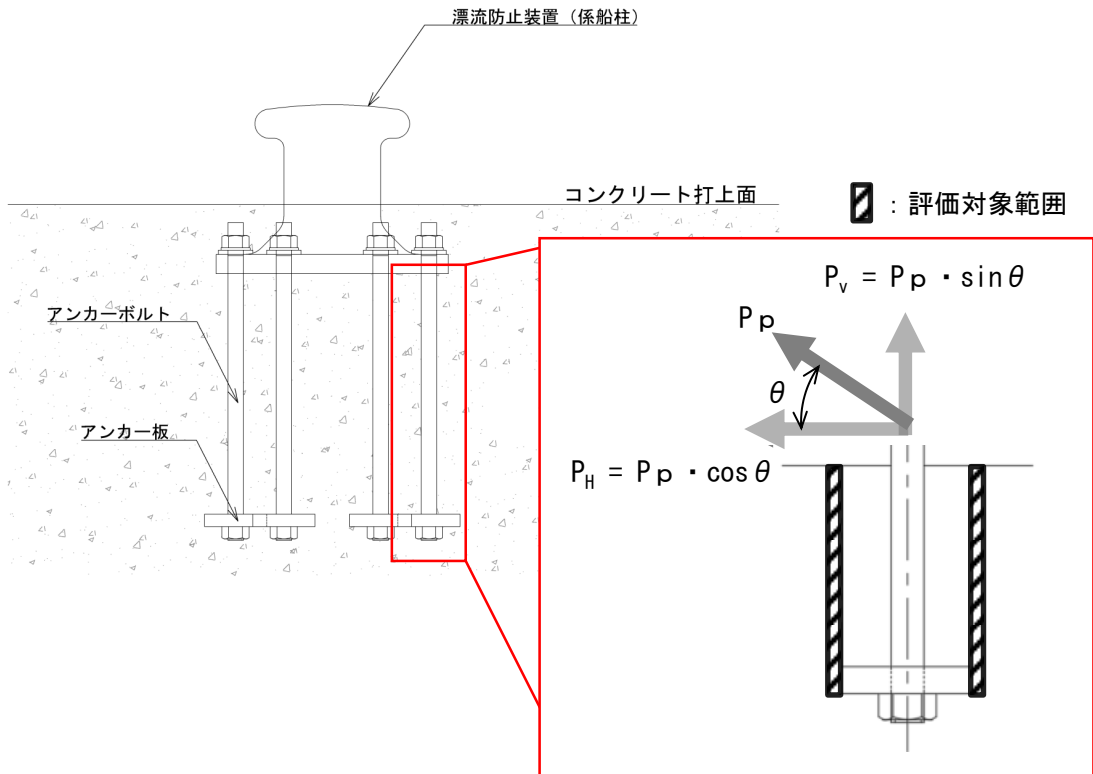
コンクリート（アンカーボルト側面）のモデル図
